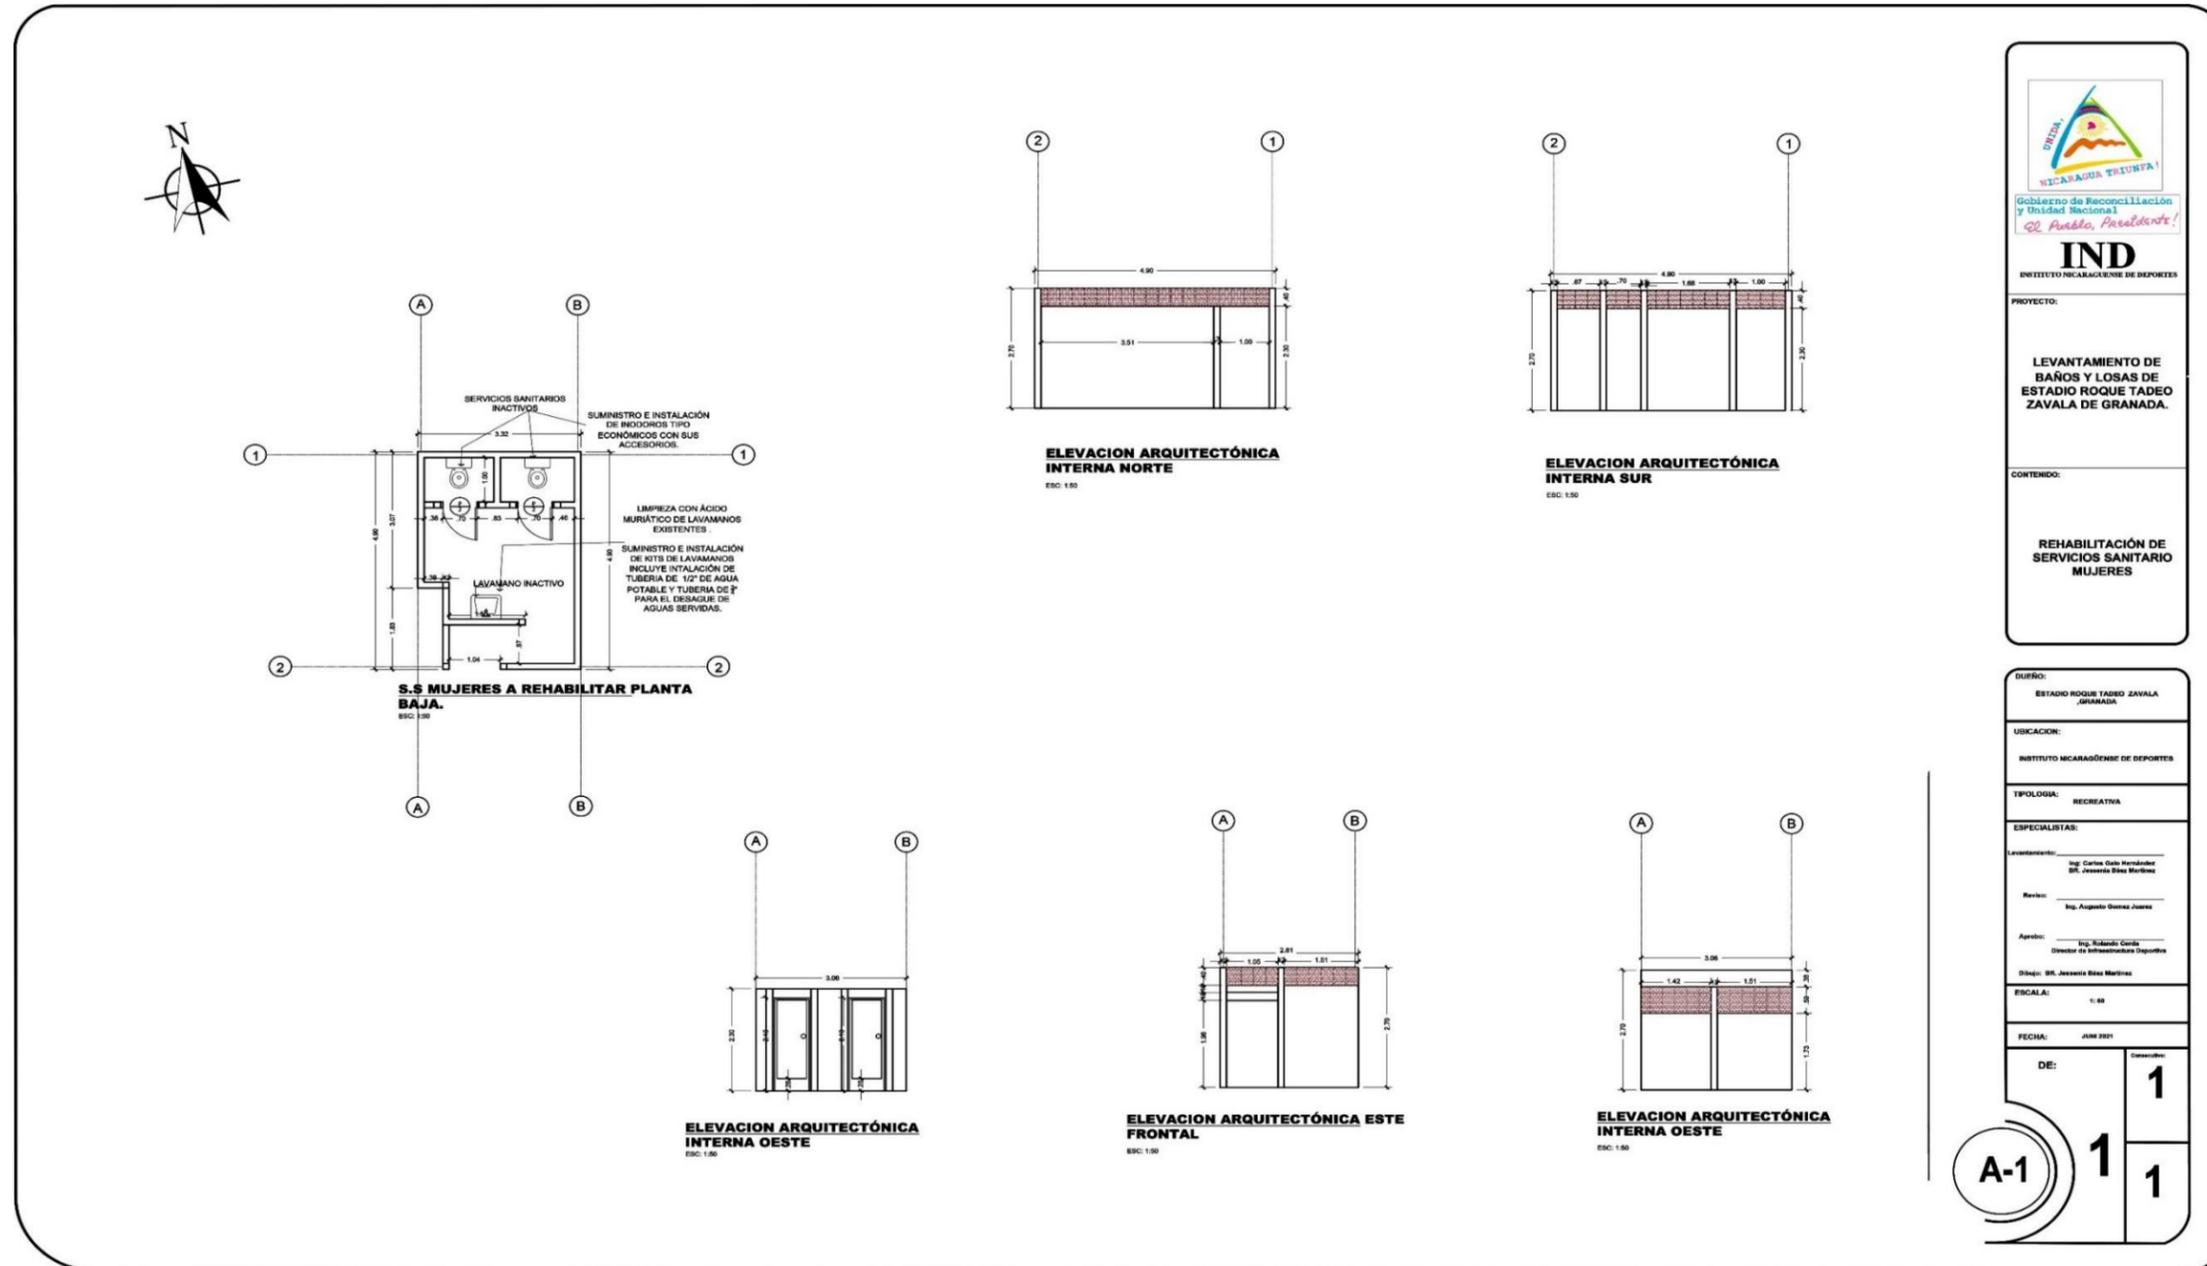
Plano de rehabilitación de planta baja de servicios sanitarios de mujeres
